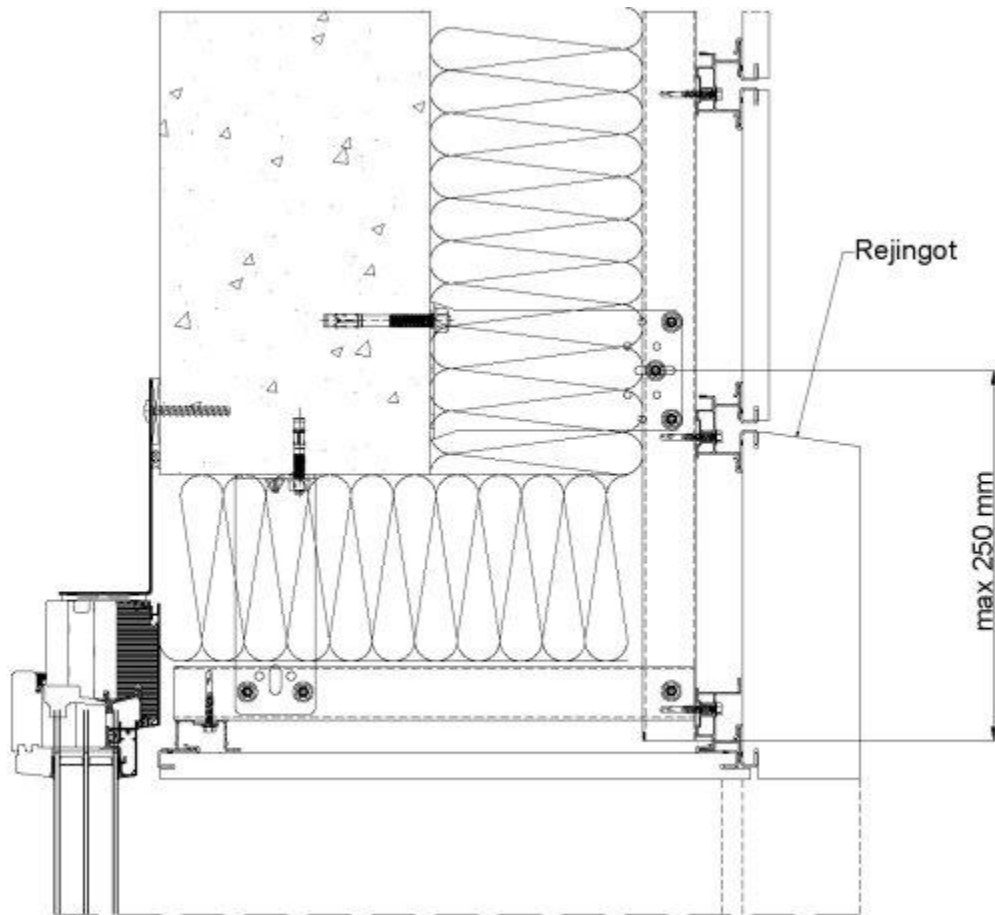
Encadrement de baie pierre épaisse + bavette pierre
